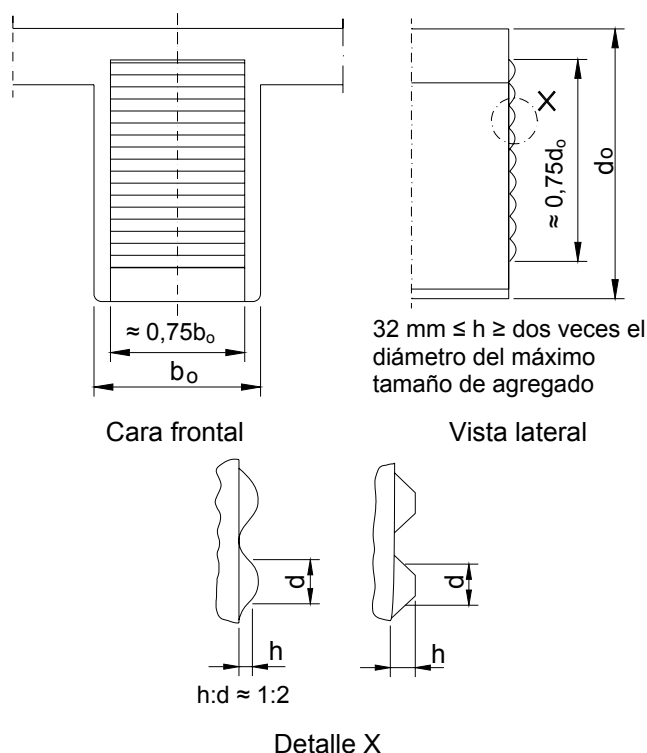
Ejemplo de conectores de corte de pequeña amplitud
